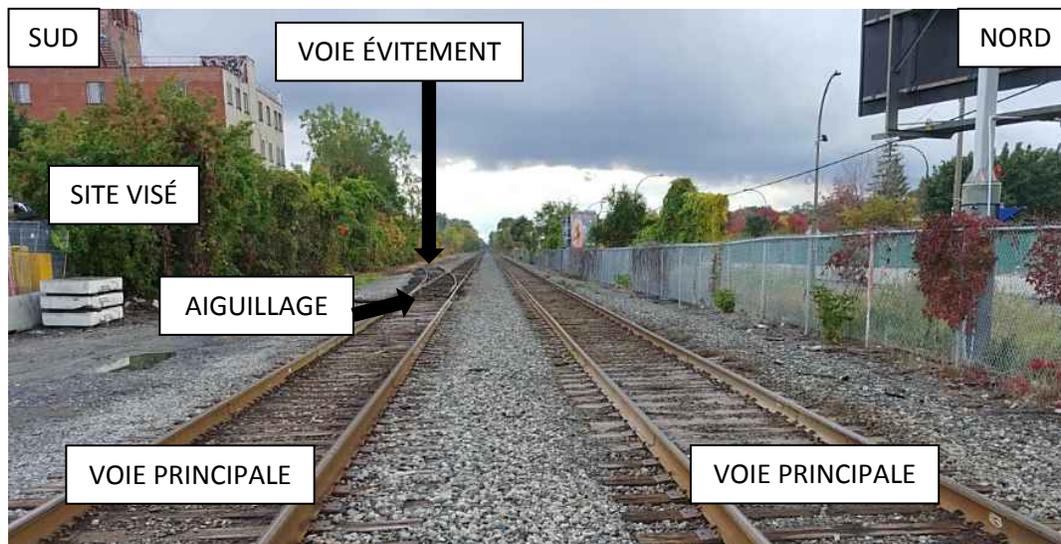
Corridor de transport ferroviaire montrant les deux voies ferrées principales au centre, l'aiguillage et la voie d'évitement au sud. (Vue regardant vers l'ouest ... vers Autoroute Décarie).
